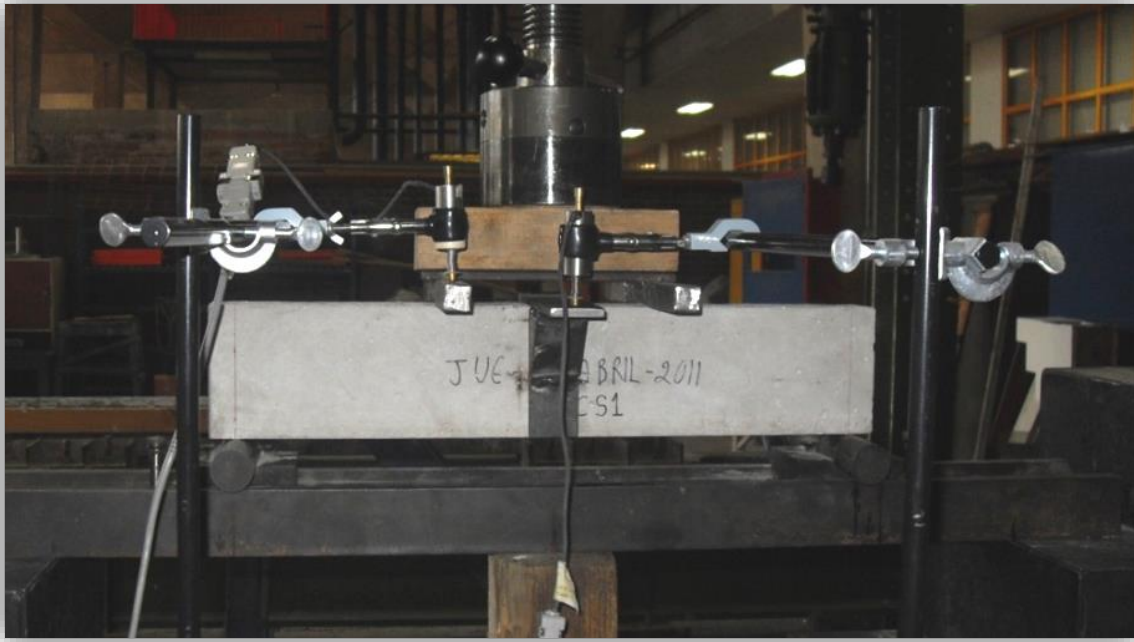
Configuración e instrumentación de las vigas en los ensayos del laboratorio
